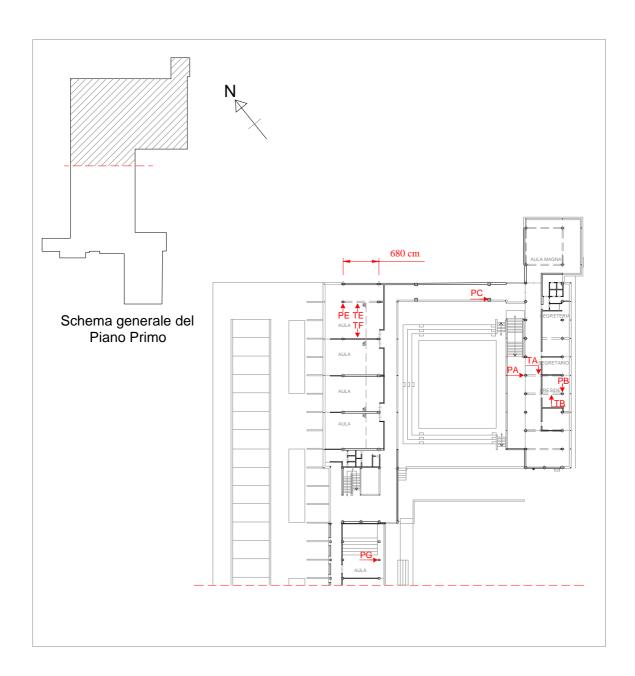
Planimetria schematica del piano primo dell'edificio.
